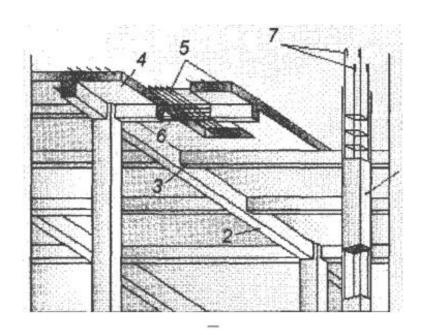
Монолитное ребристое перекрытие: 1 — колонна; 2 — главная балка; 3- второстепенная балка; 4 — плита; 5 — рабочая арматура плиты; 6,7 — то же соответственно второстепенной и главной балок и колонн.
